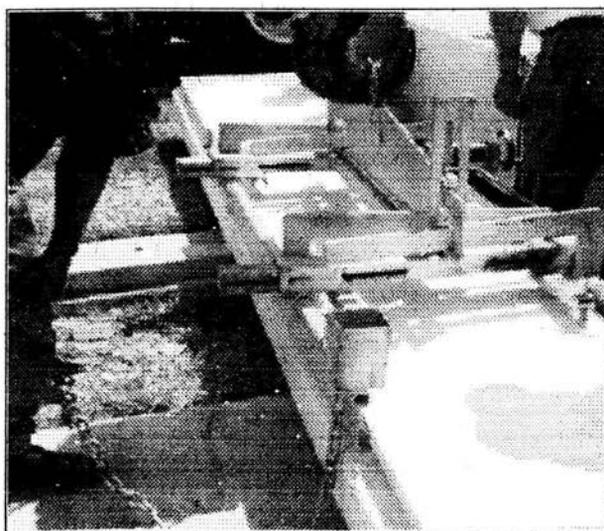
En la fotografía se muestra la colocación de la tenaza, herramienta útil para el izaje de paneles de concreto celular con acero de refuerzo.
